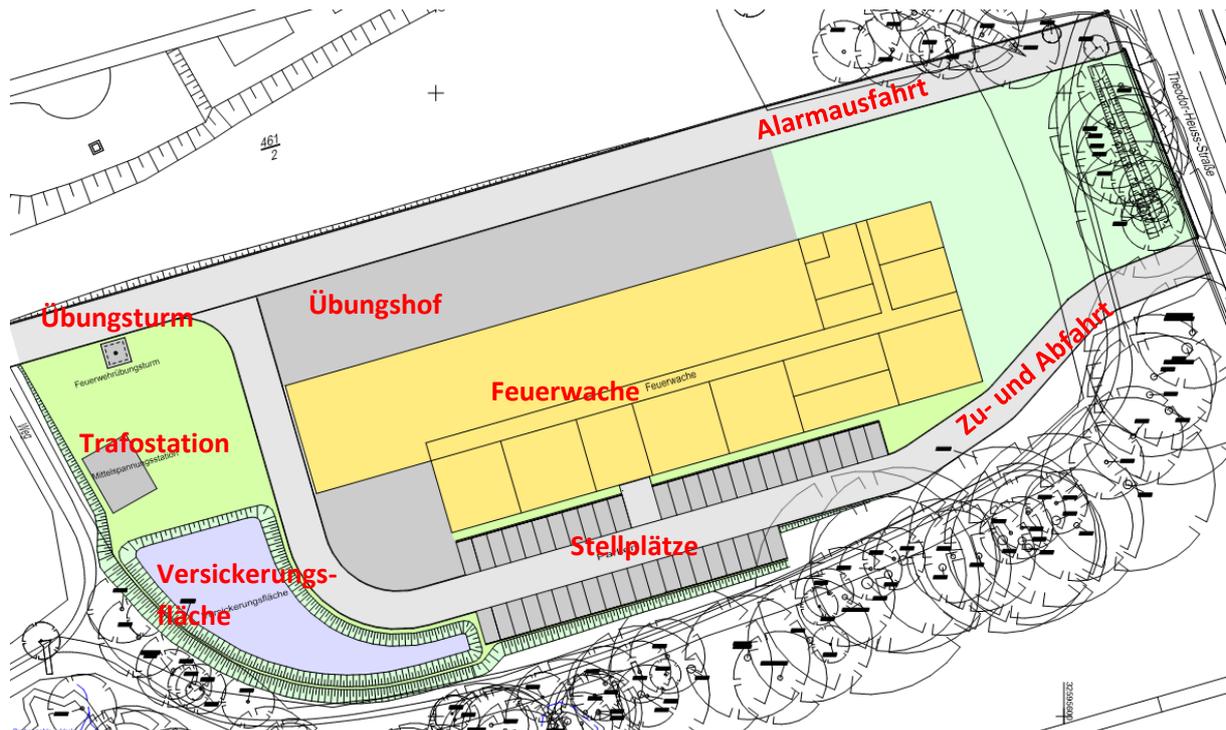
Lageplan zum Entwässerungskonzept, vereinfachte Darstellung (Quelle: Ingenieurbüro Feuerbach 2024). Die Darstellung ist unverbindlich. Es gelten die Festsetzungen im Bebauungsplan.
